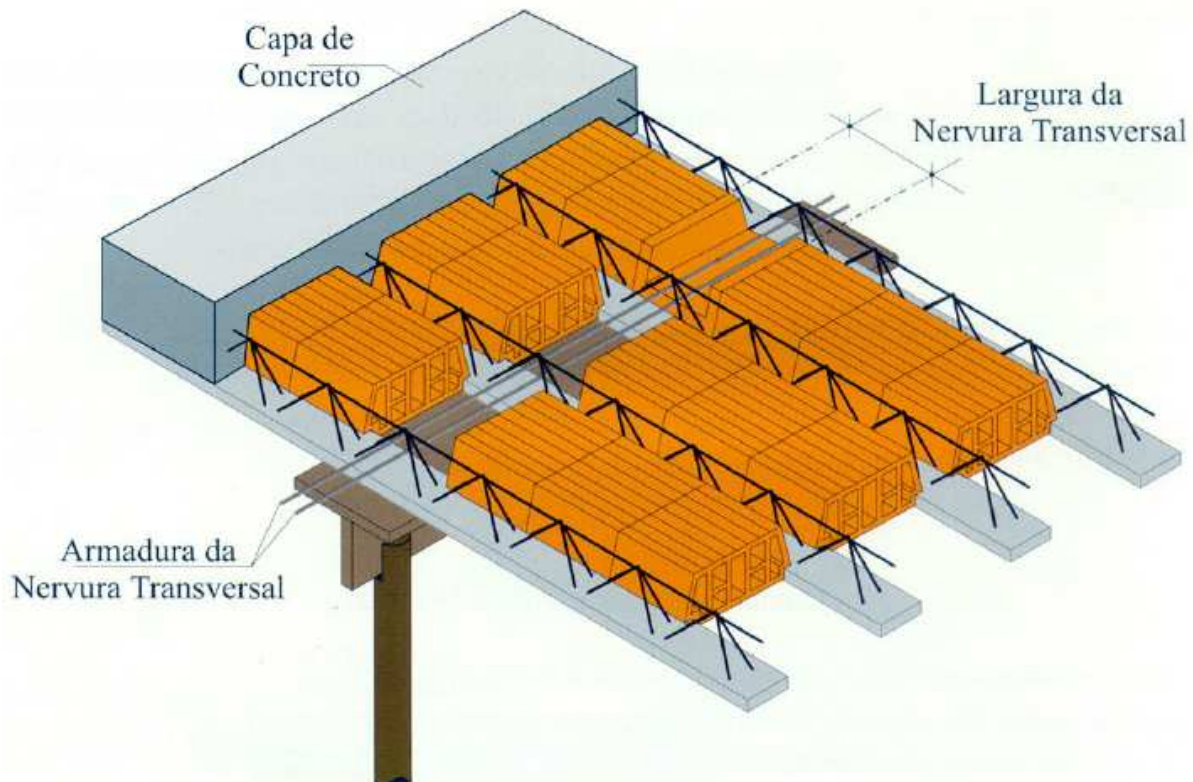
Nervura transversal às vigotas treliçadas.
